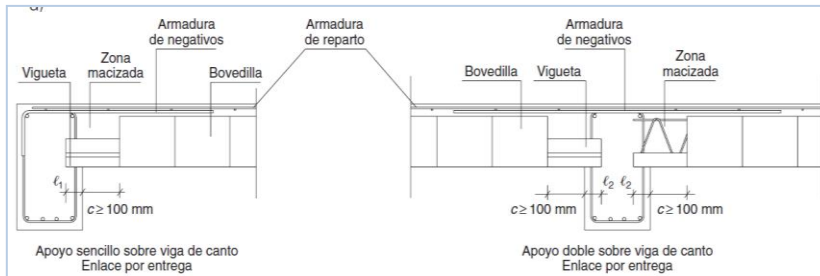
y 14. Apoyo sobre viga de canto. Enlace por entrega
